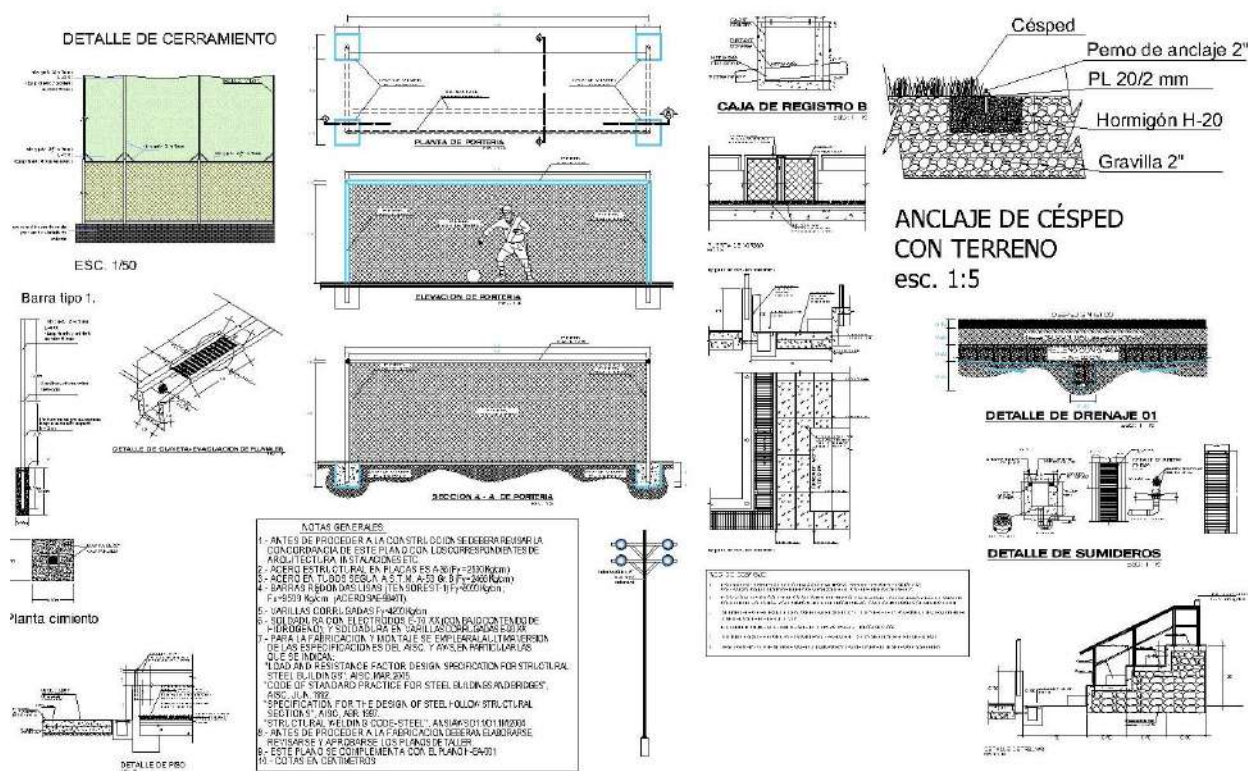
Detalles constructivos cancha fútbol sala. Fuente: Elaboración propia 2021.
